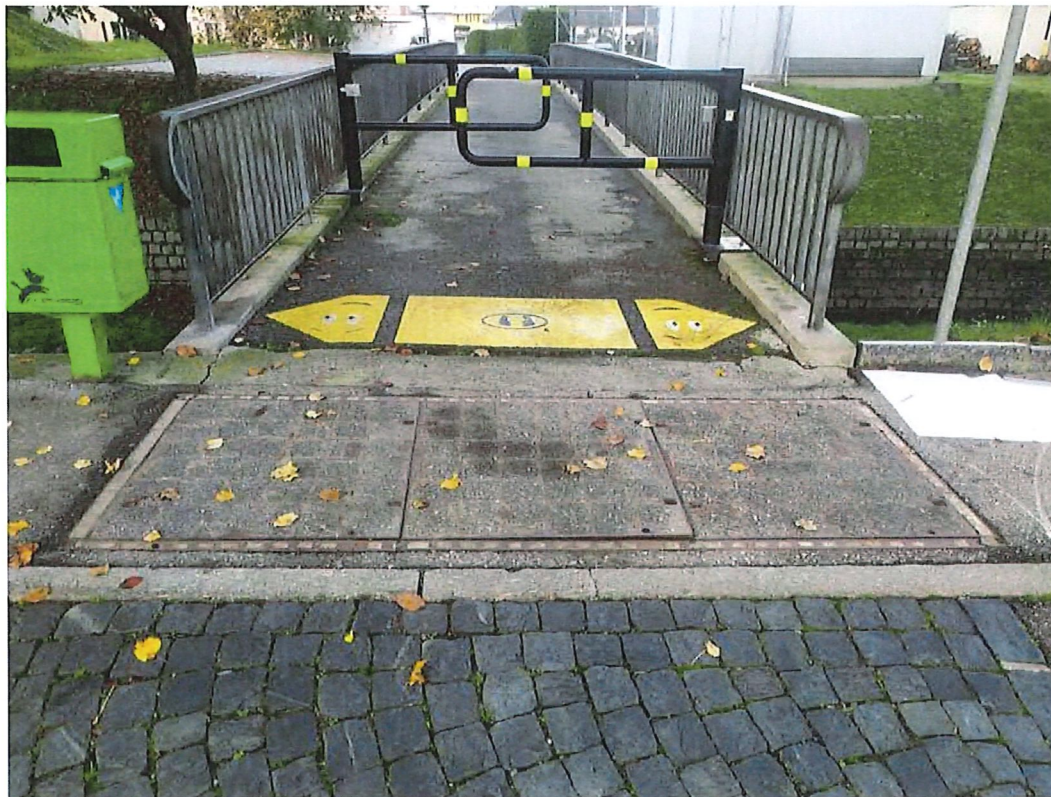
Accesso passerella dalle Scuole con camera AMB
